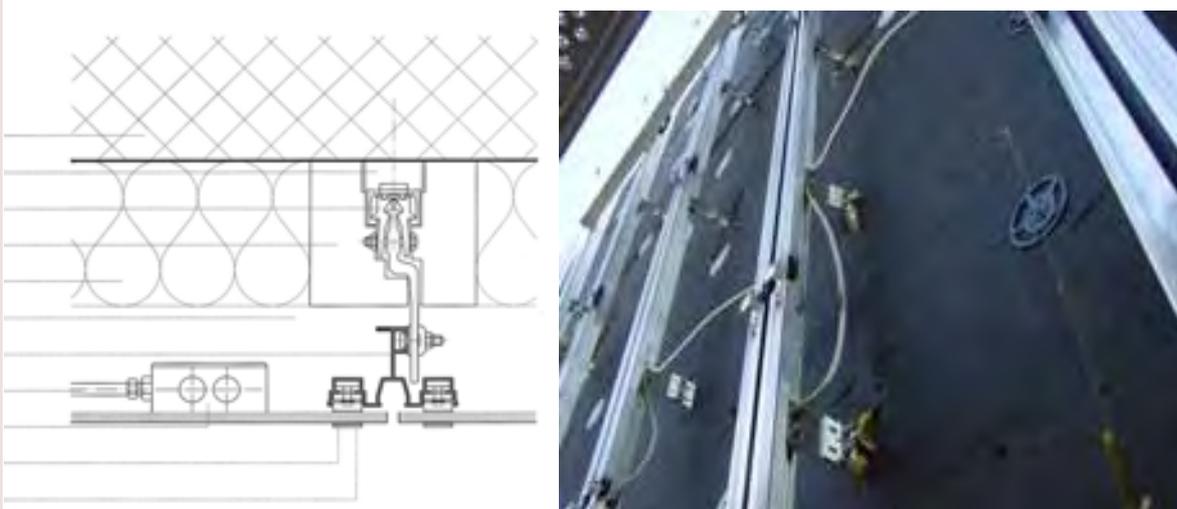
Detalles de la estructura y los fijadores de la Fachada Fotovoltaica Verde de Tübingen (Alemania).
